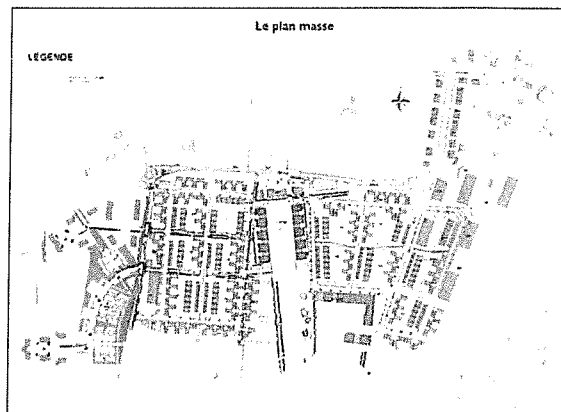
Plan de masse du projet (source : SEDA nov. 2020)
